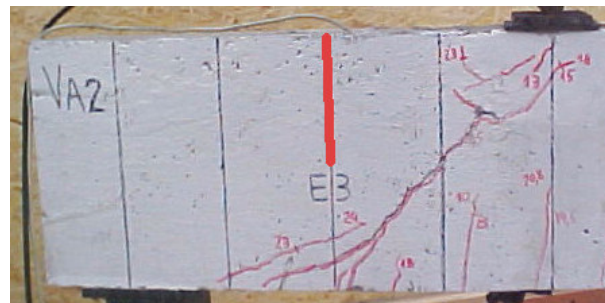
Detalhe da fissuração em E3 e posição dos extensômetros
